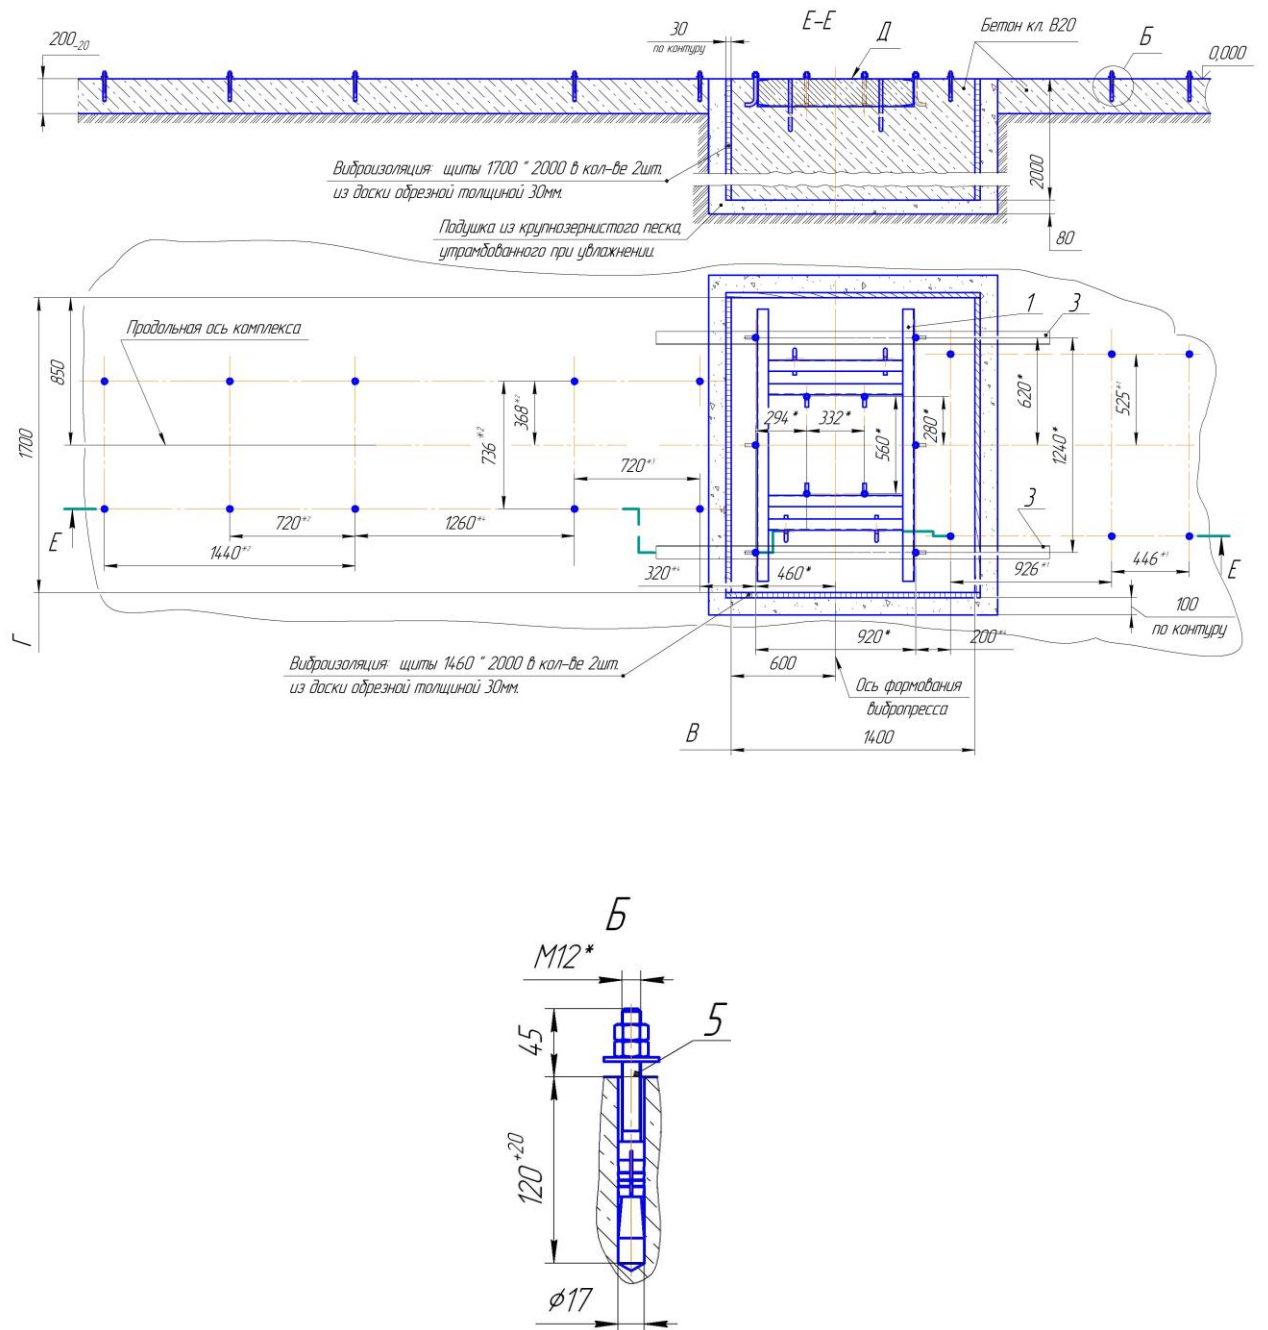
План фундамента комплекса Лидер-Цвет
